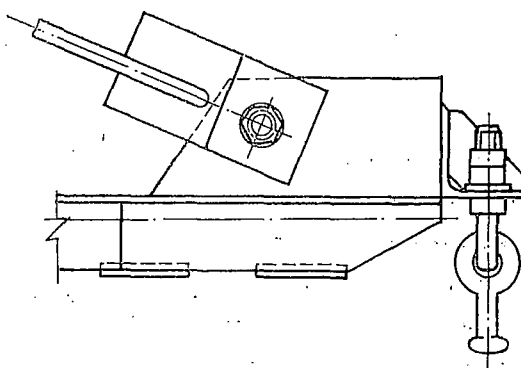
Крепление гирлянды на траверсе железобетонных опор
